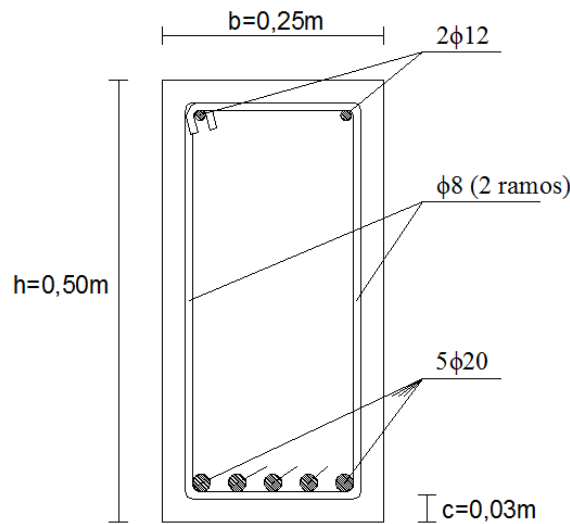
Esboço da secção da viga para a zona de meio vão.
